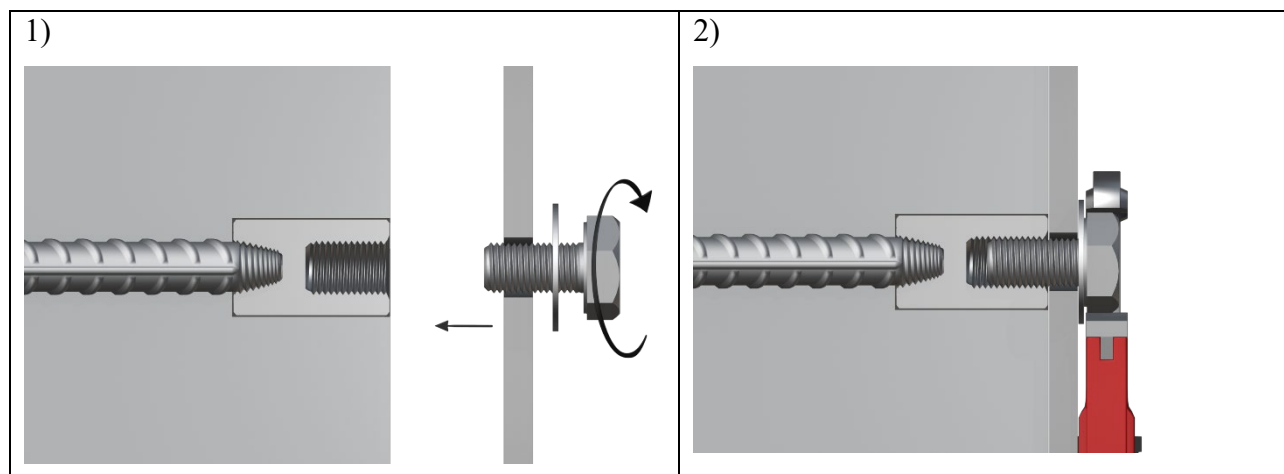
Сборка соединений под метрический болт (Изменить под цилиндрическую резьбу)
